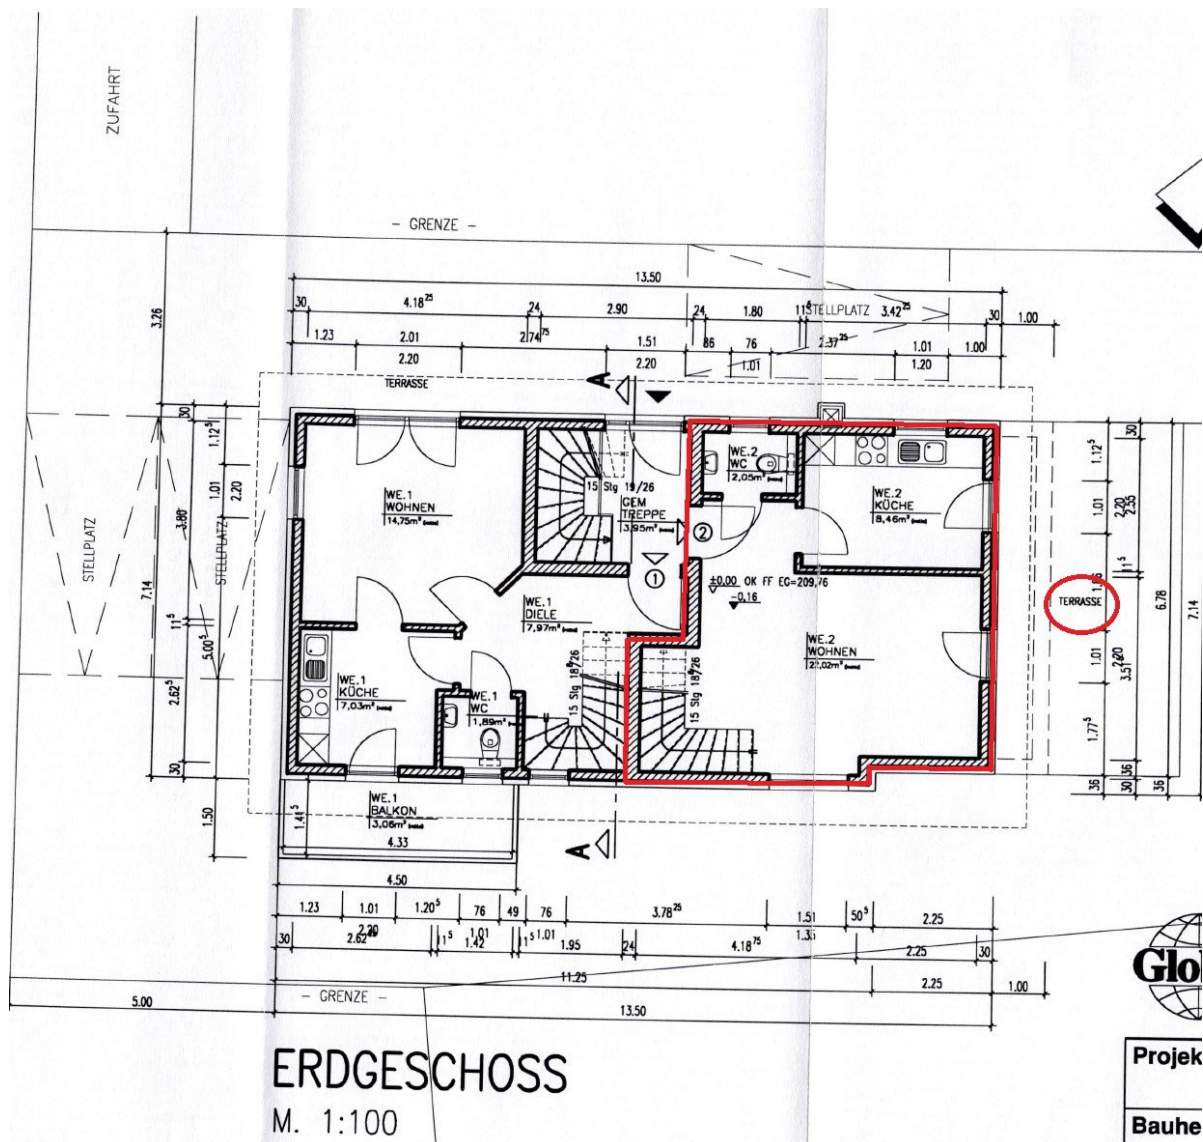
Grundriss Erdgeschoss (Abgeschlossenheitspläne)
